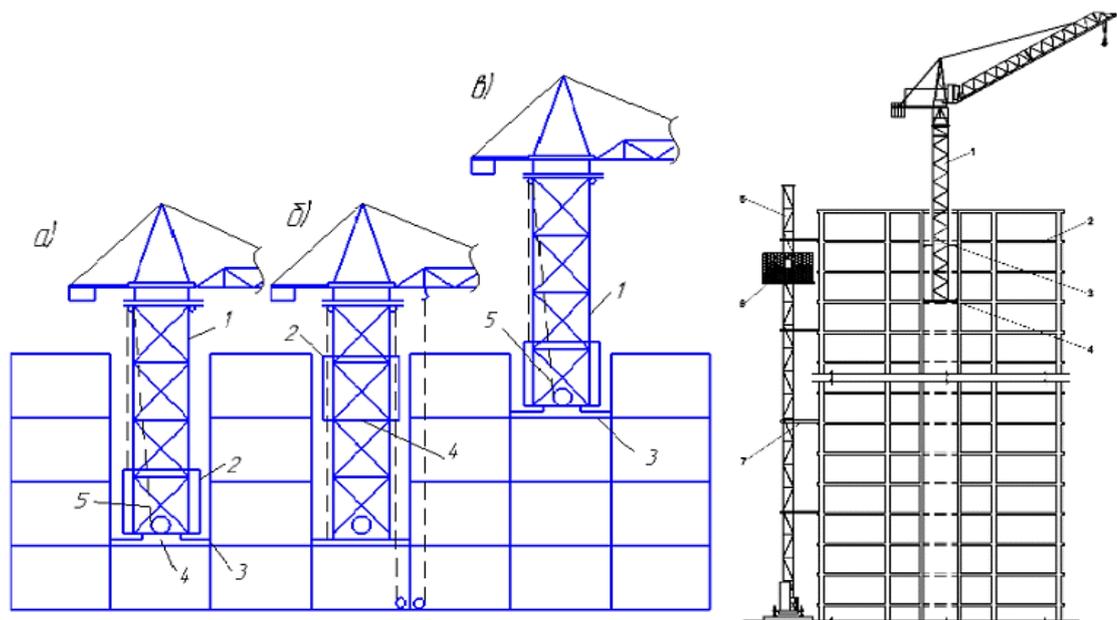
Схема само перемещаемого башенного крана (динамическое исполнение) [3 – 13]
